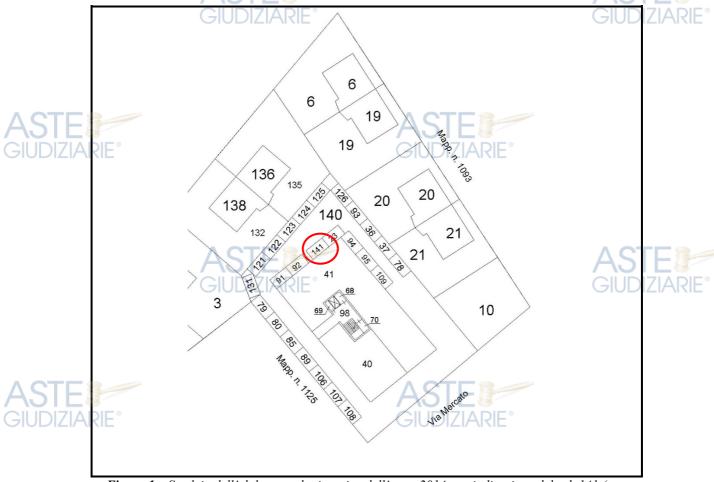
Stralcio dell'elaborato planimetrico dell'anno 2014 con indicazione del sub 141 (cerchiato in rosso)
